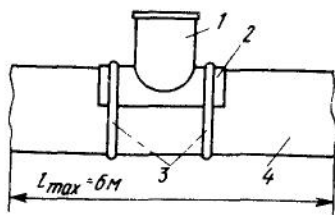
Прямой участок воздуховода с врезкой на монтаже:
